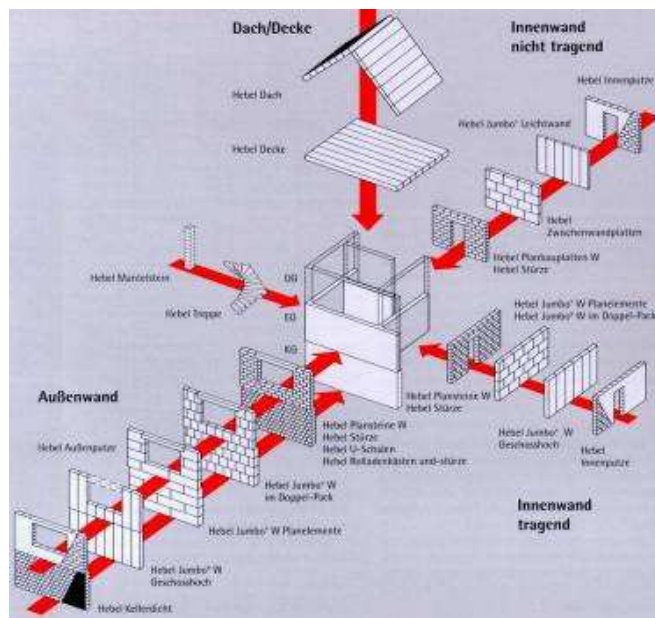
Detalhes da construção moderna em alvenaria cerâmica estrutural na Alemanha
